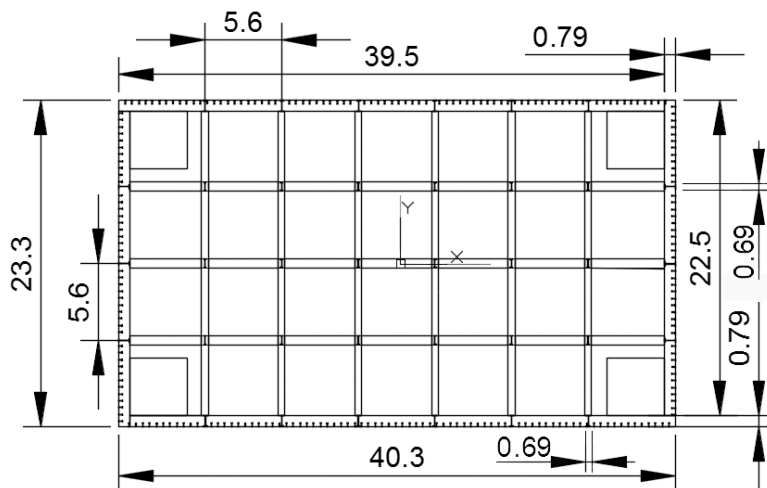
Secção S2 em planta, desenhada em AutoCAD
